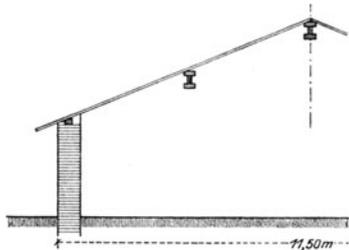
Gebäudequerschnitt. Dach mit Trägerrahmen nach Bauweise Kaper.
